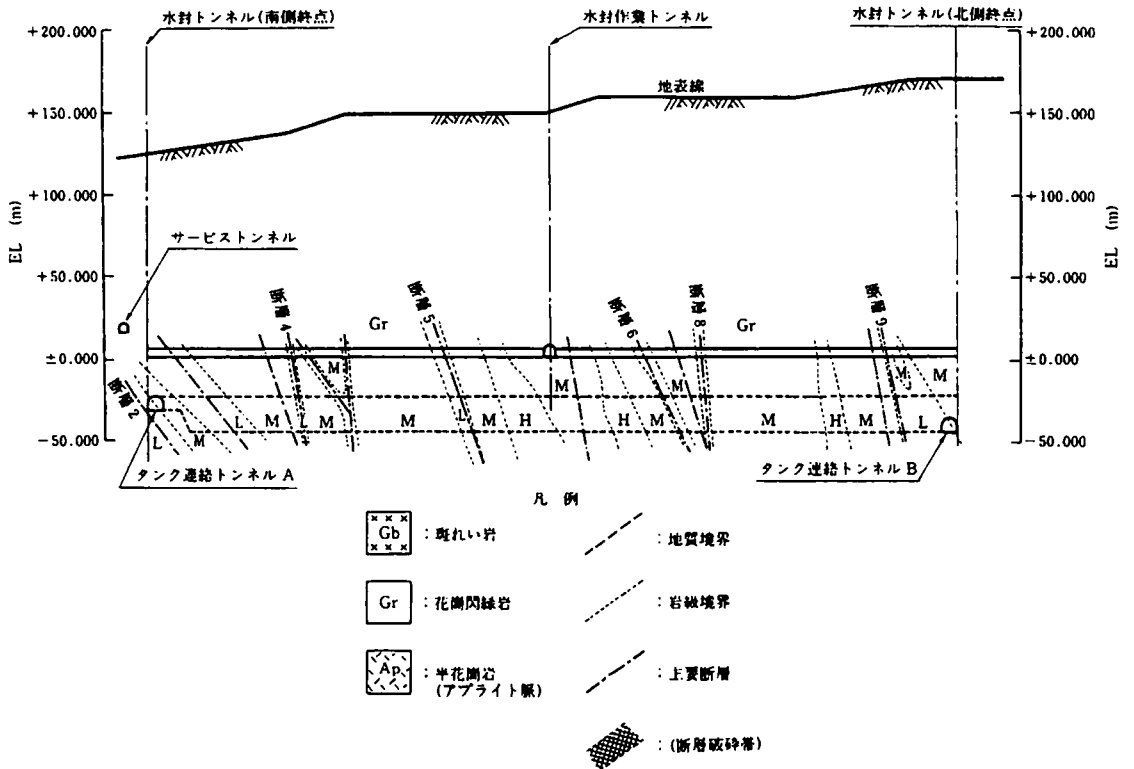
13. 3 地質断面図 (水封トンネル No.5 断面, No.6 断面)
